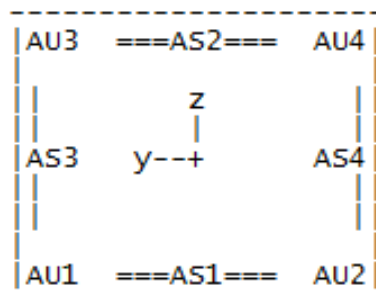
Схема армирования №1, без выделения угловой арматуры
